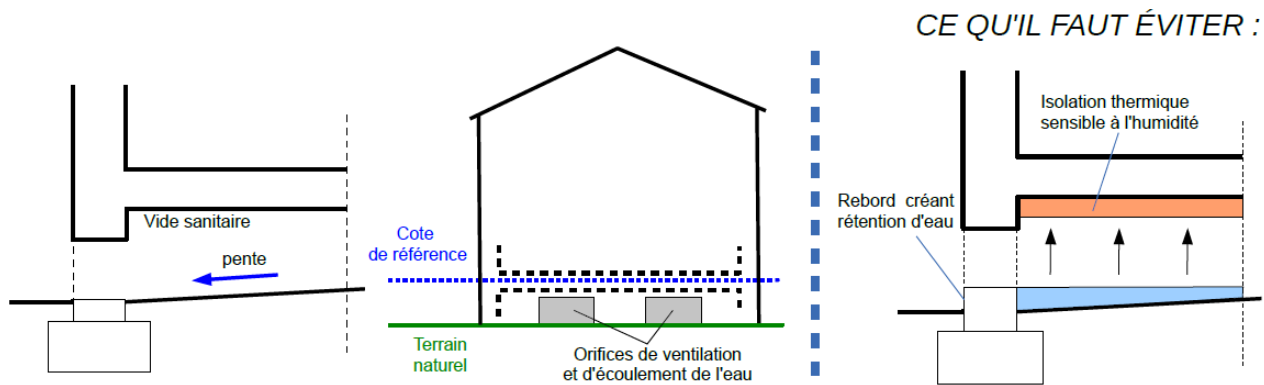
Principe de construction sur vide sanitaire (source: PPRL de Oye-Plage à Gravelines)
